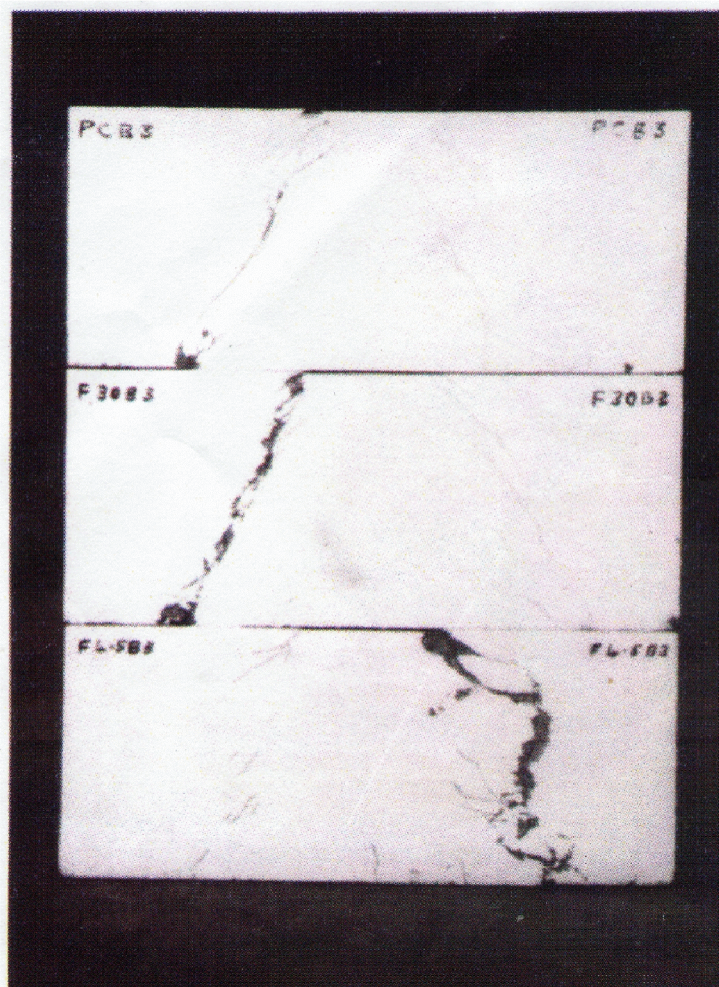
Mode de fissurations des poutres testées pour $a/d=8$ [16].
